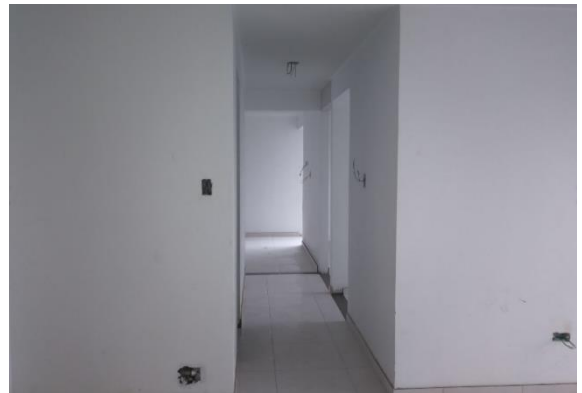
Apartamento perteneciente a la torre A del proyecto, fuente propia
